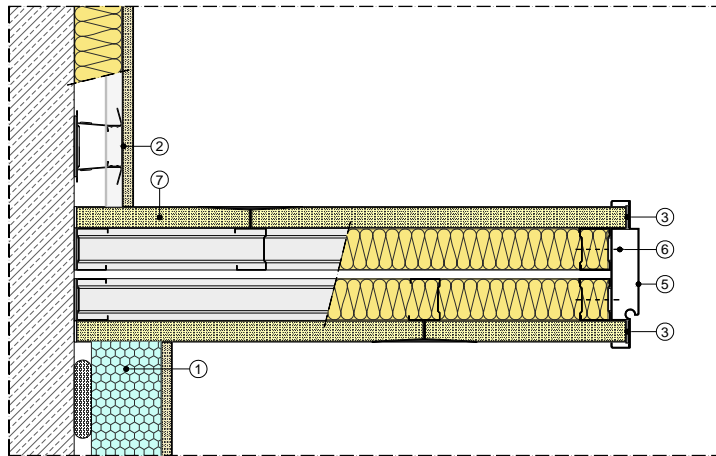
Raccordement aux parois verticales et sur huisserie métallique
